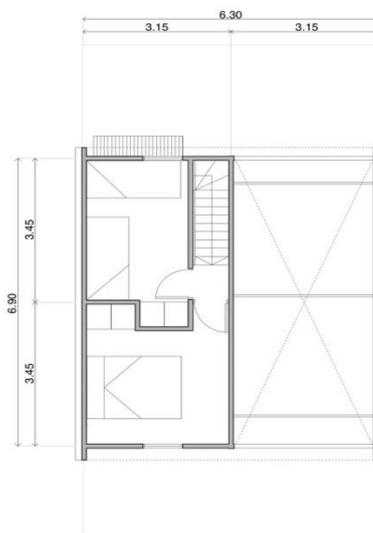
Planta Baixa Pavimento Térreo - Habitação Villa Verde / Elemental
